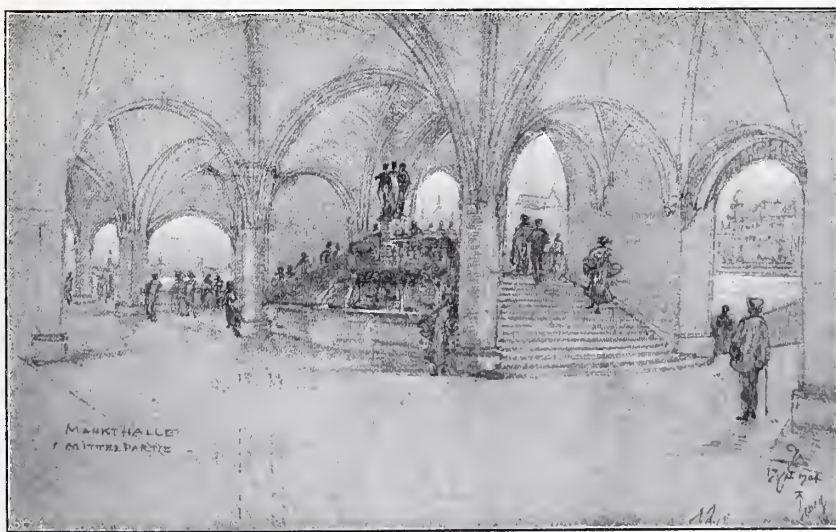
Entwurfskizze der Mittelpartie der untern Markthalle mit dem Treppenaufgang zur Terrasse vor dem Gebäude des grossen Stadtrats.
